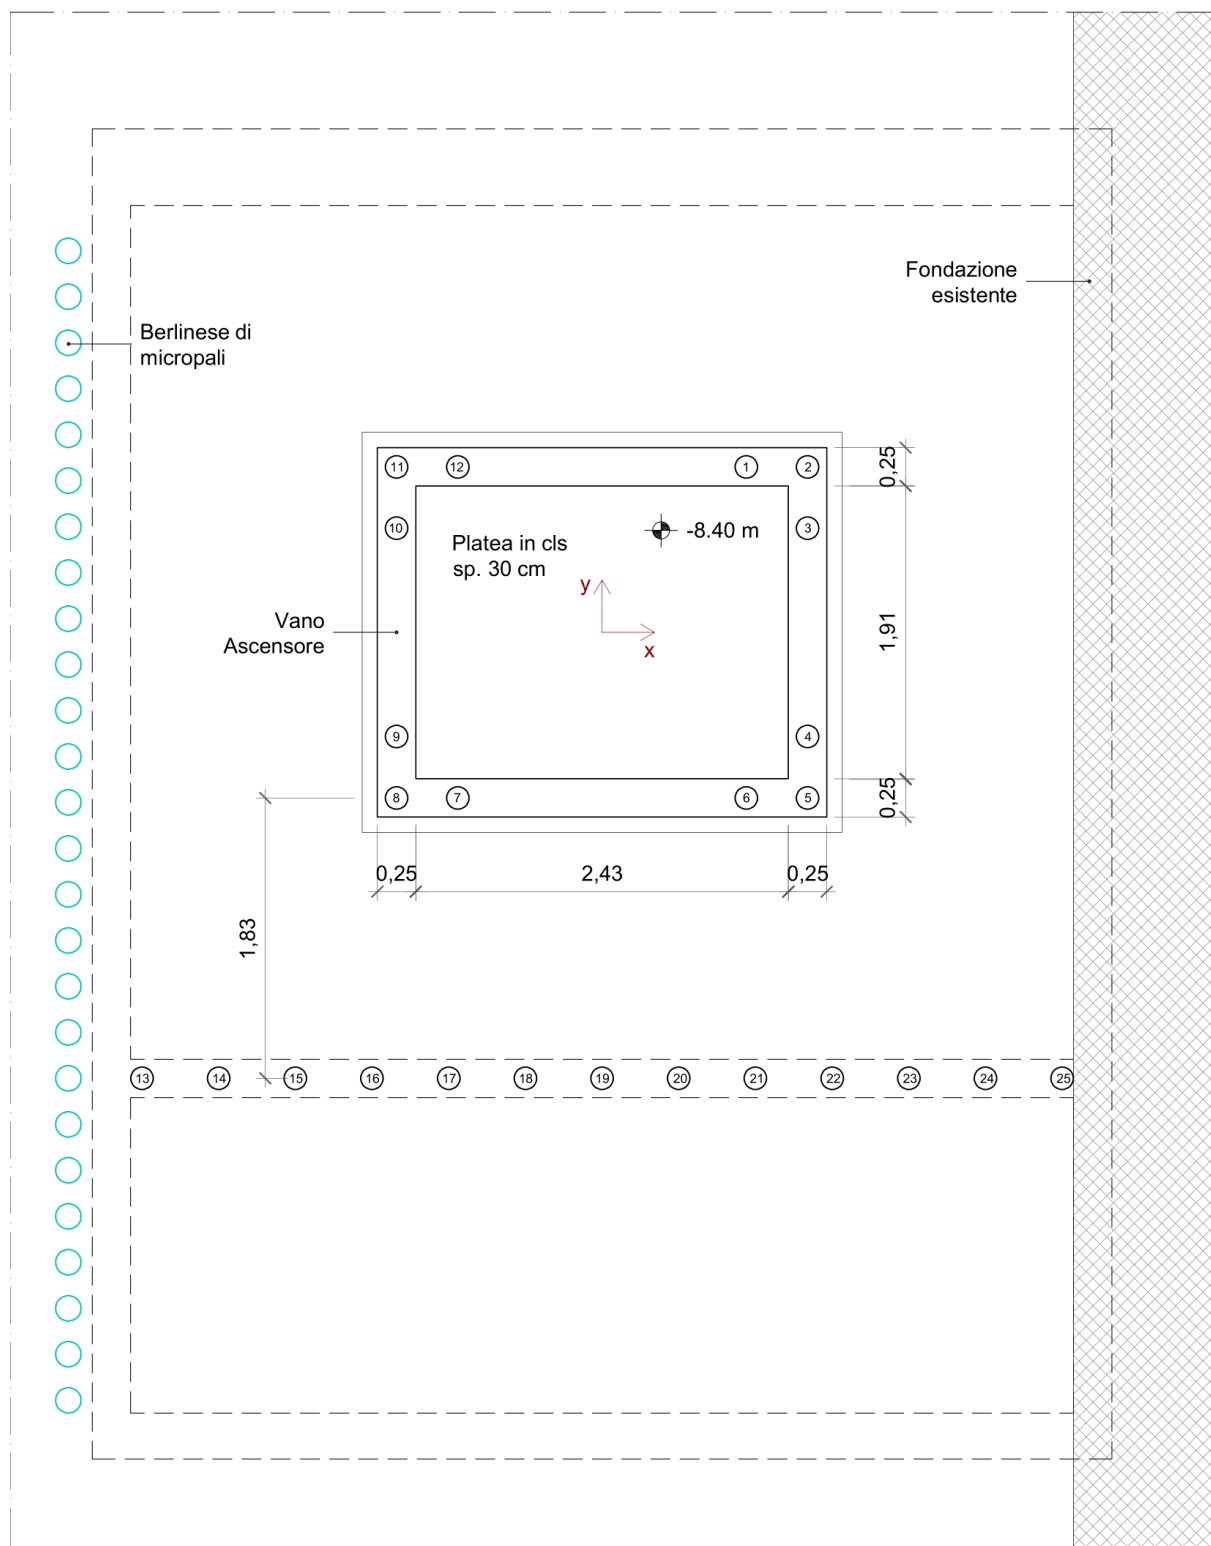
Disposizione planimetrica dei micropali - scala E.
